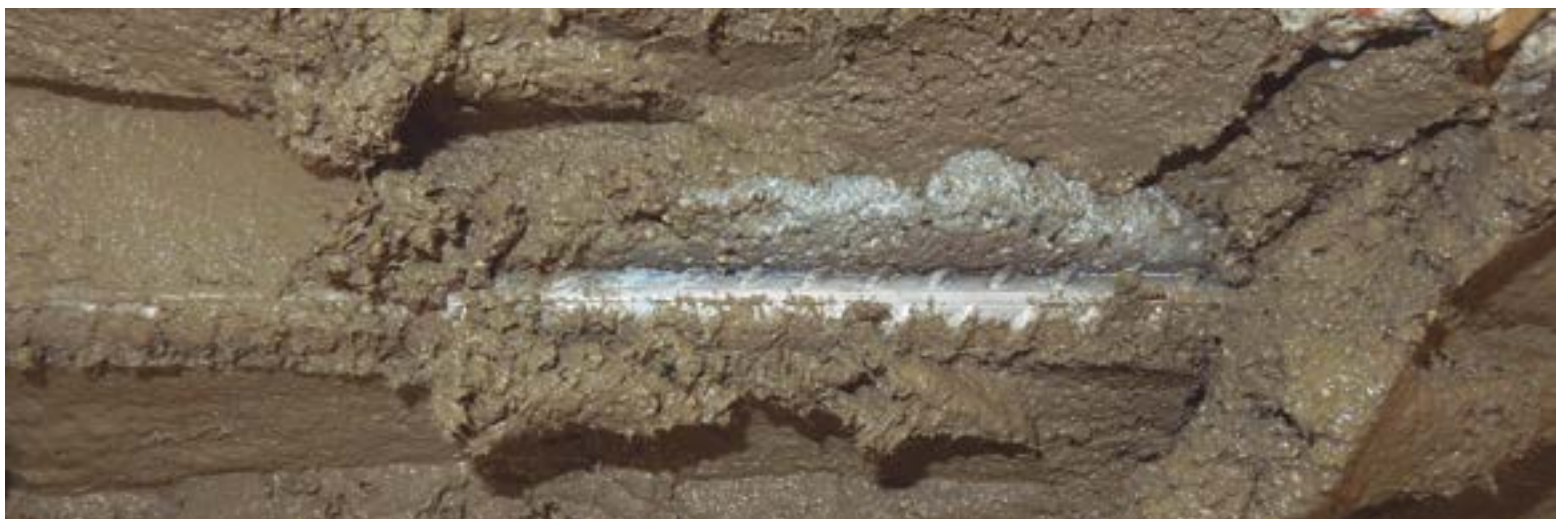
Detalle de reconstrucción de volúmenes con mortero de reparación
